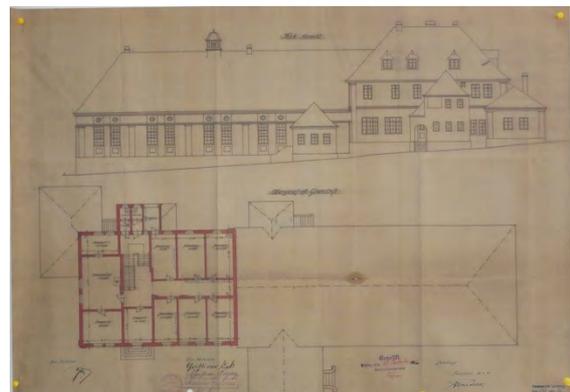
Grundriss Obergeschoss + Ansicht Süd
